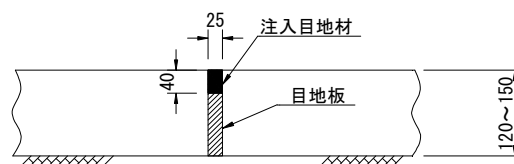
横目地の構造例 (単位: mm) ¹⁾
